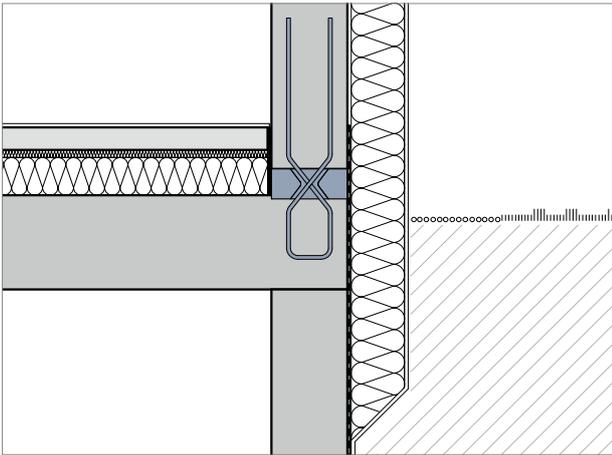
Schöck Sconnex® type W pour mur extérieur et isolation sur la dalle
